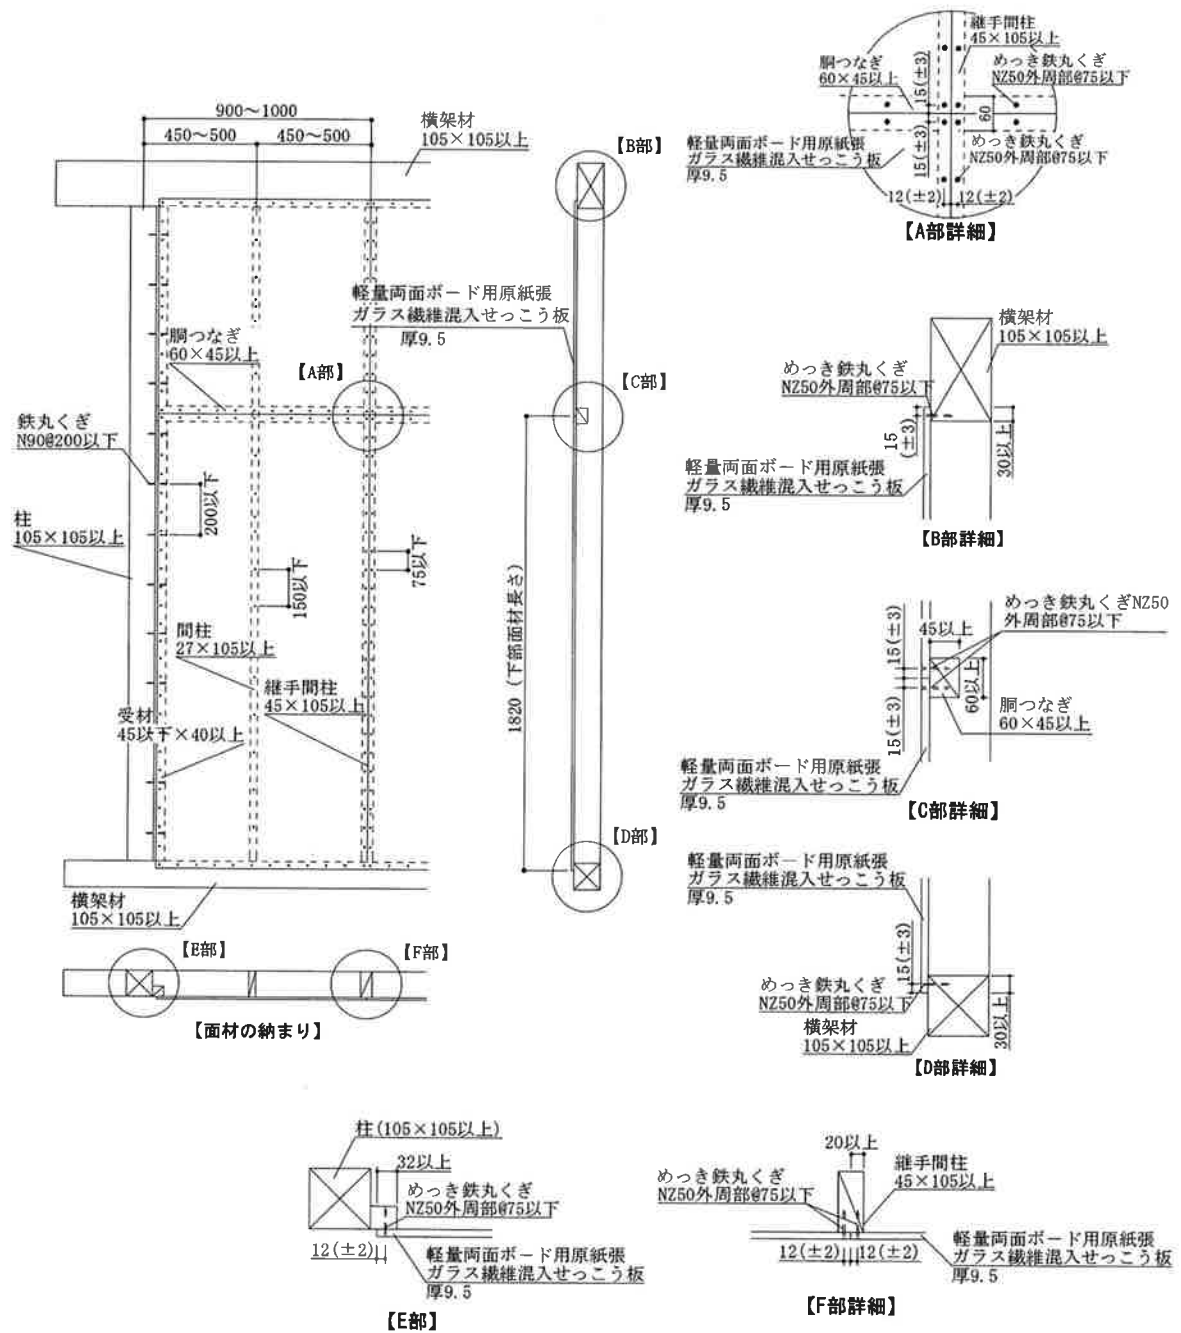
施工図：縦継ぎ張りの場合 (寸法単位：mm)
